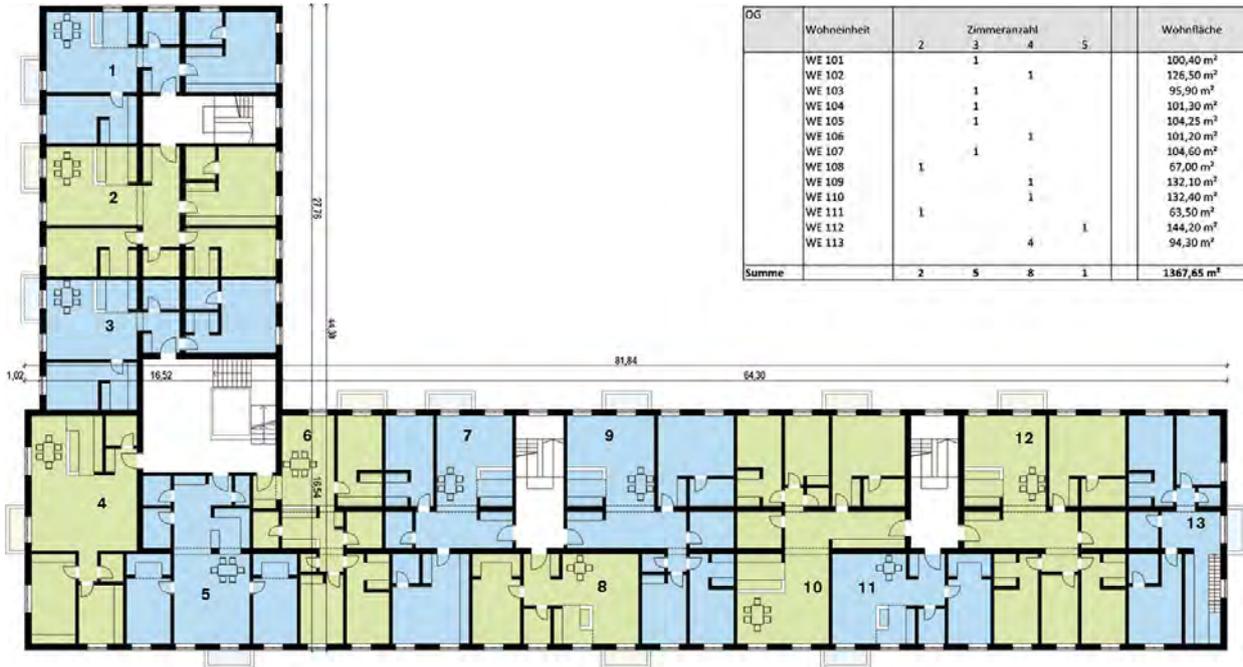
Grundriss der Umplanung des Gebäudes K 17 (1.0G)
